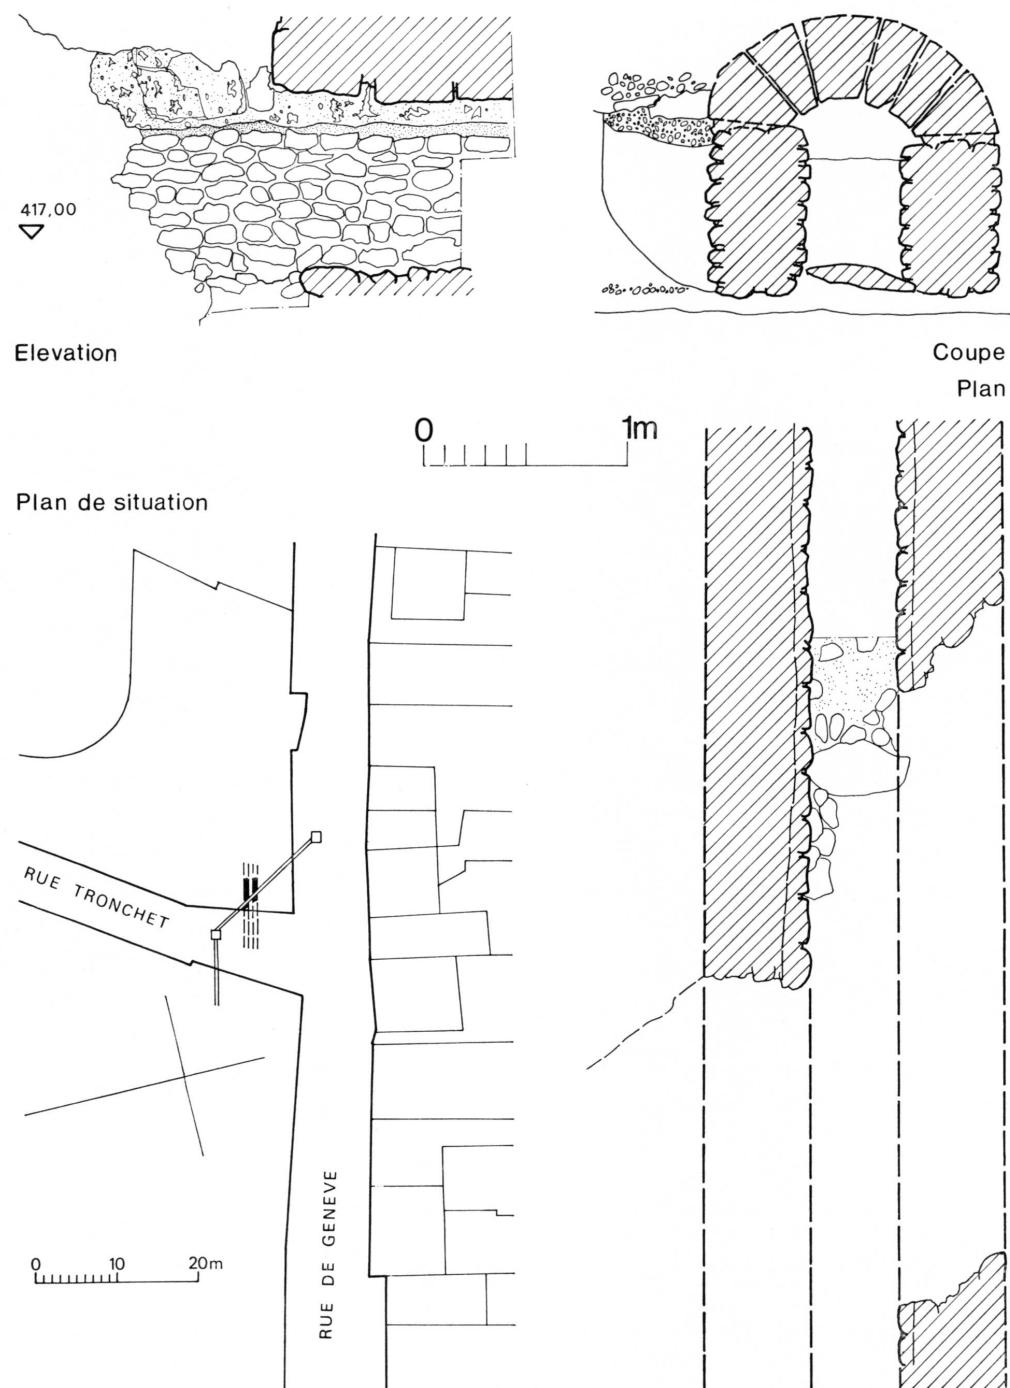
Thônex. Moillesulaz. Aqueduc romain. Plan de situation. Ech.: 1:1000. — Plan et élévation. Ech.: 1:40.
